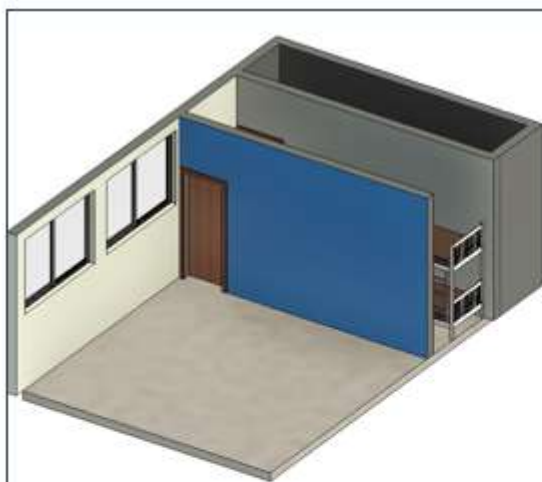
Projeto 1 (dois), sala do Comandante a parede destacada em azul será elevada com estrutura Light Steel Framing e se estenderá até a altura de 3,60 m, até o forro. A parede a ser elevada possui as dimensões 5,20 m de comprimento, com porta de 0,80 m de largura por 2,60 m de altura. Com os devidos componentes elétricos como tomadas, interruptores e luminárias.
